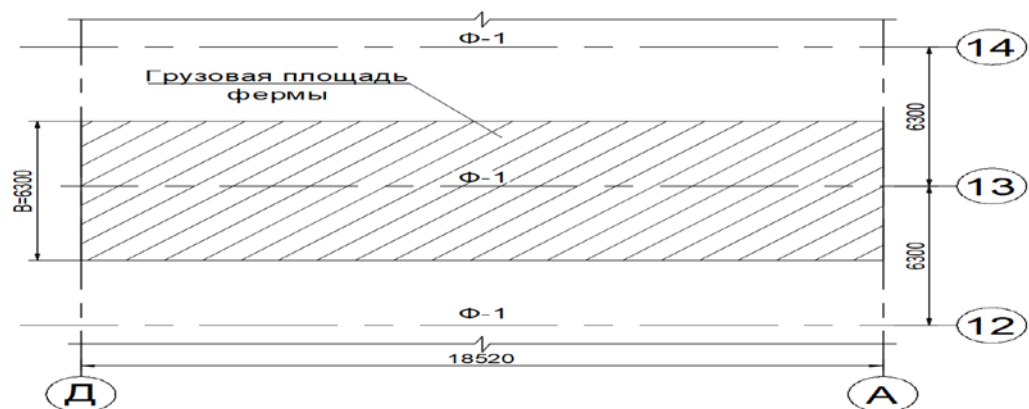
«Площадь фермы грузовая» [9]
